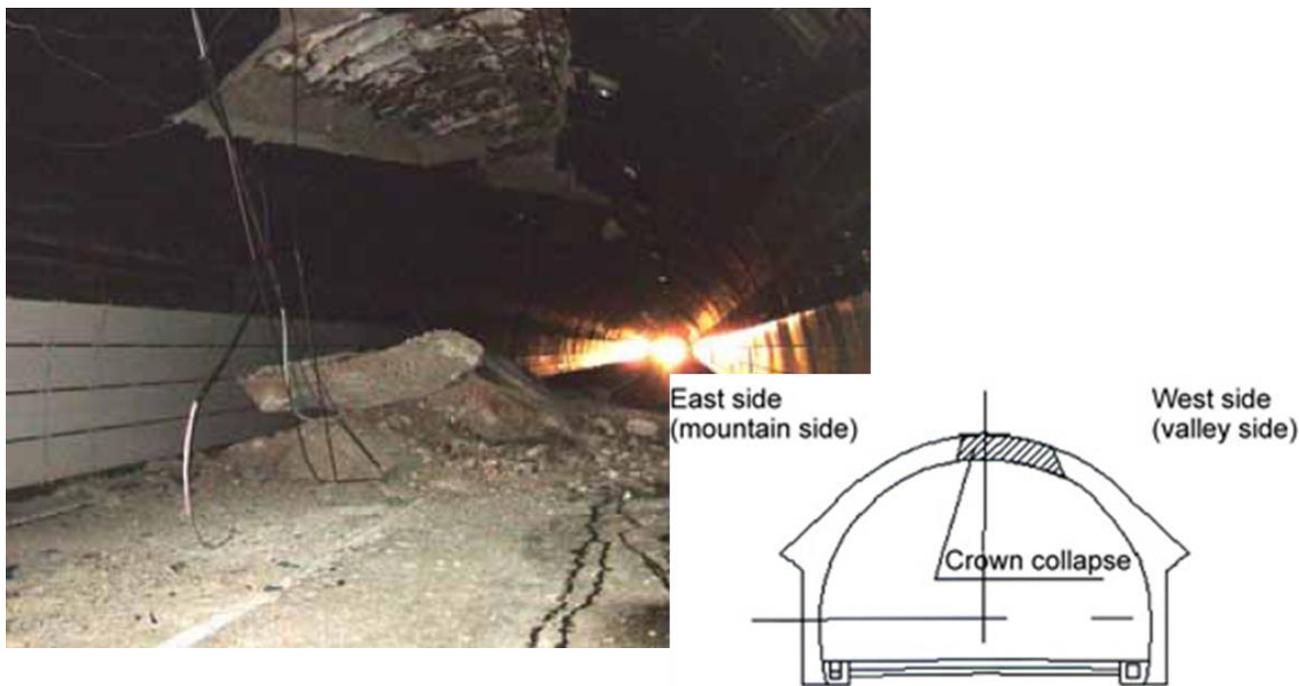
Tunnel Lining Falling from Tunnel Crown - 2004 Niigata Earthquake, Japan
